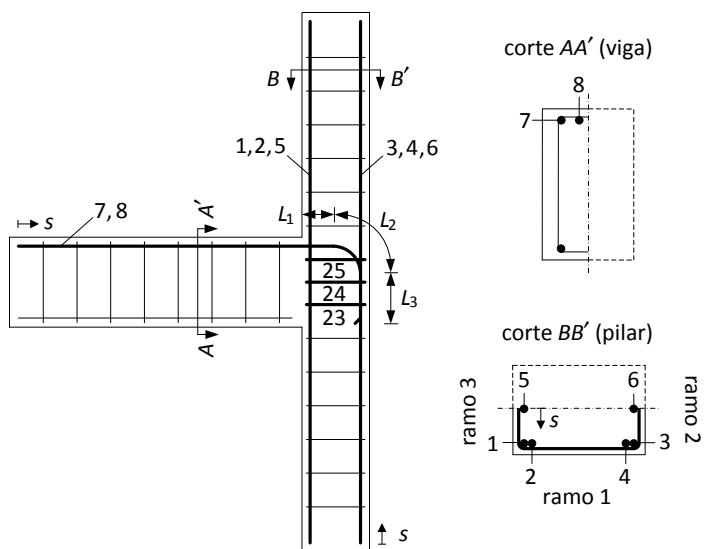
Numeração dos elementos da armadura da viga, pilares e ligação dos modelos BCJ4/BCJ3.
